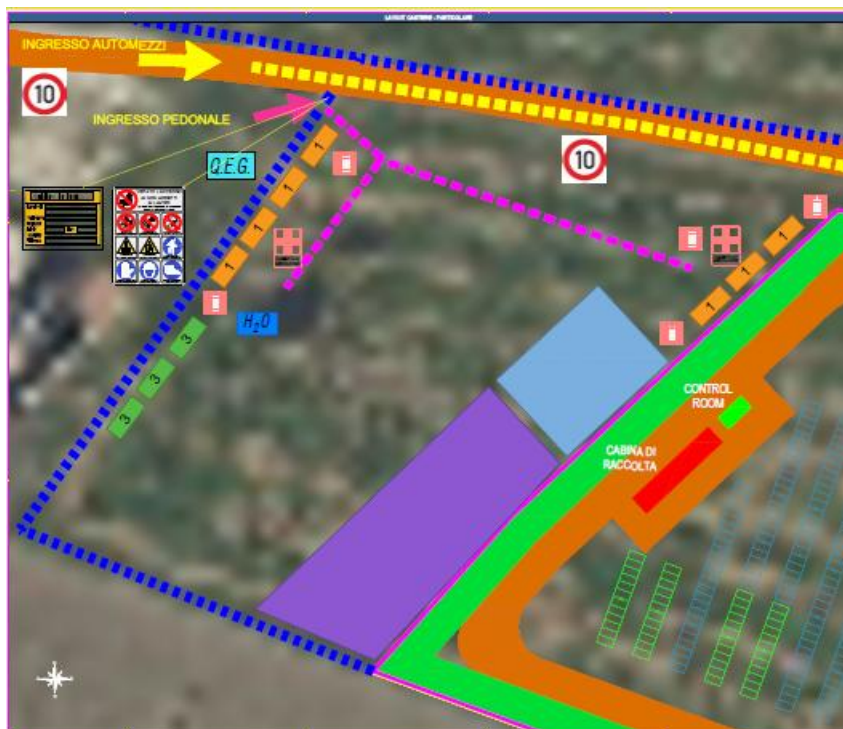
Inquadramento su ortofoto dell'area di accantieramento
